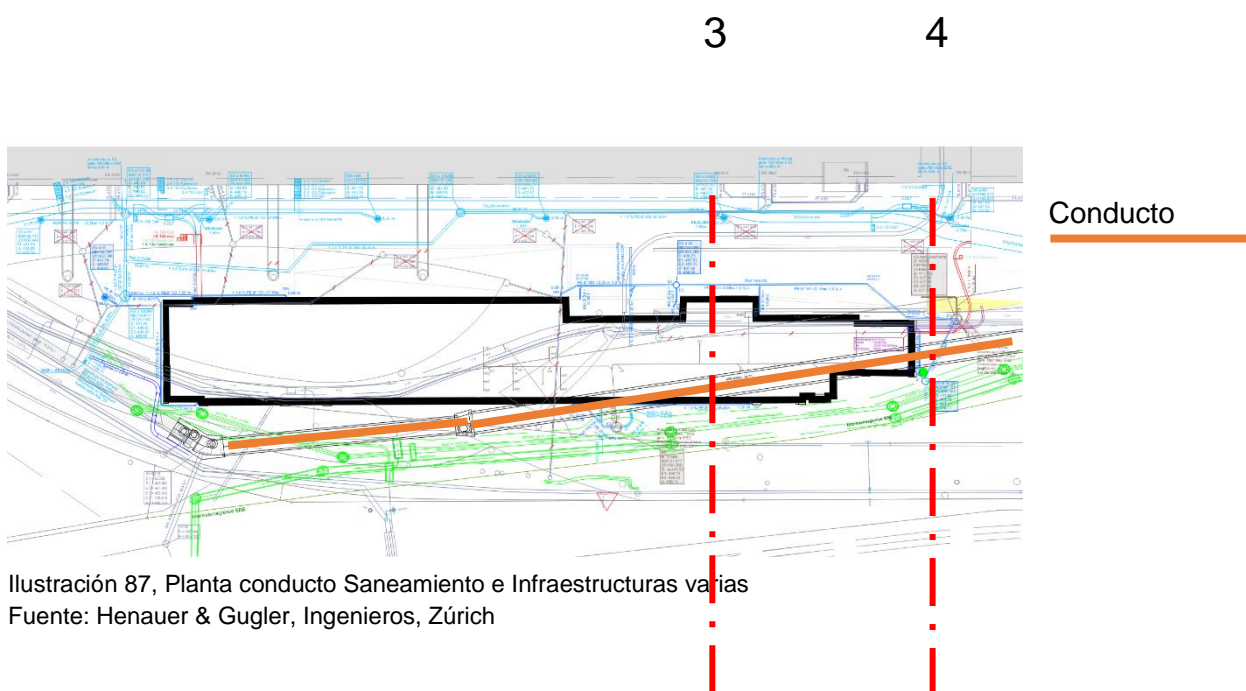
, Planta conducto Saneamiento e Infraestructuras varias
